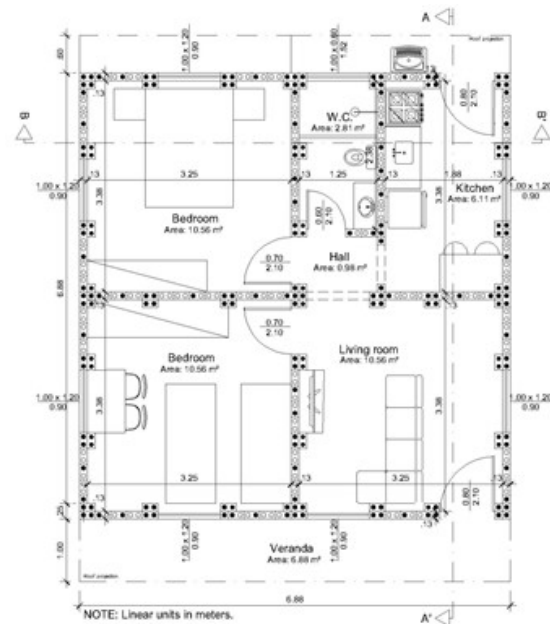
Planta baixa da Casa SHS-Multirisco 1.0 [14].
